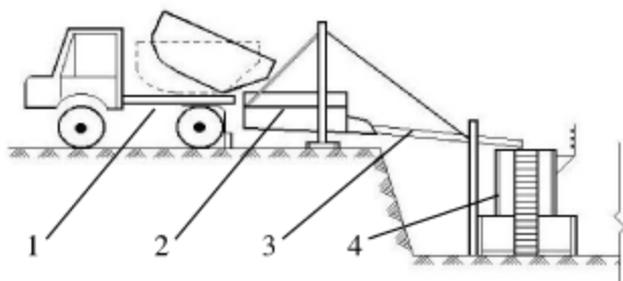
Бетонирование фундамента с разгрузкой бетонной смеси из транспортного средства непосредственно в опалубку:
